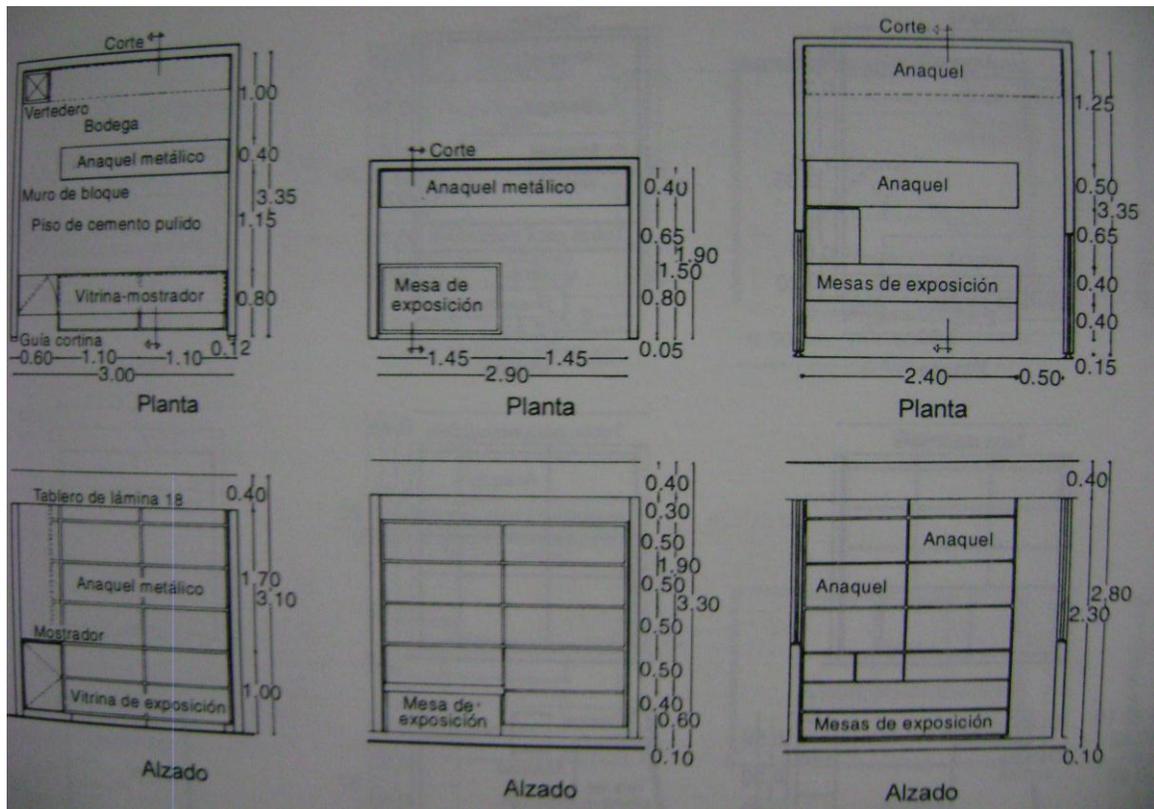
Dimensiones de locales, vistas en planta y alzado.
